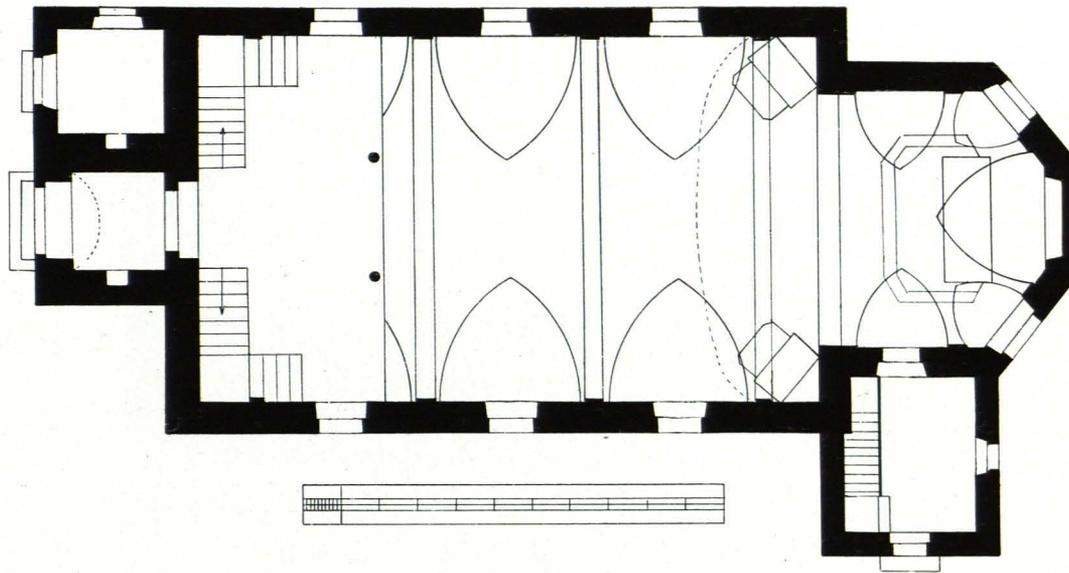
Plainfeld. Pfarrkirche, Grundriß 1:200 (S. 444)
